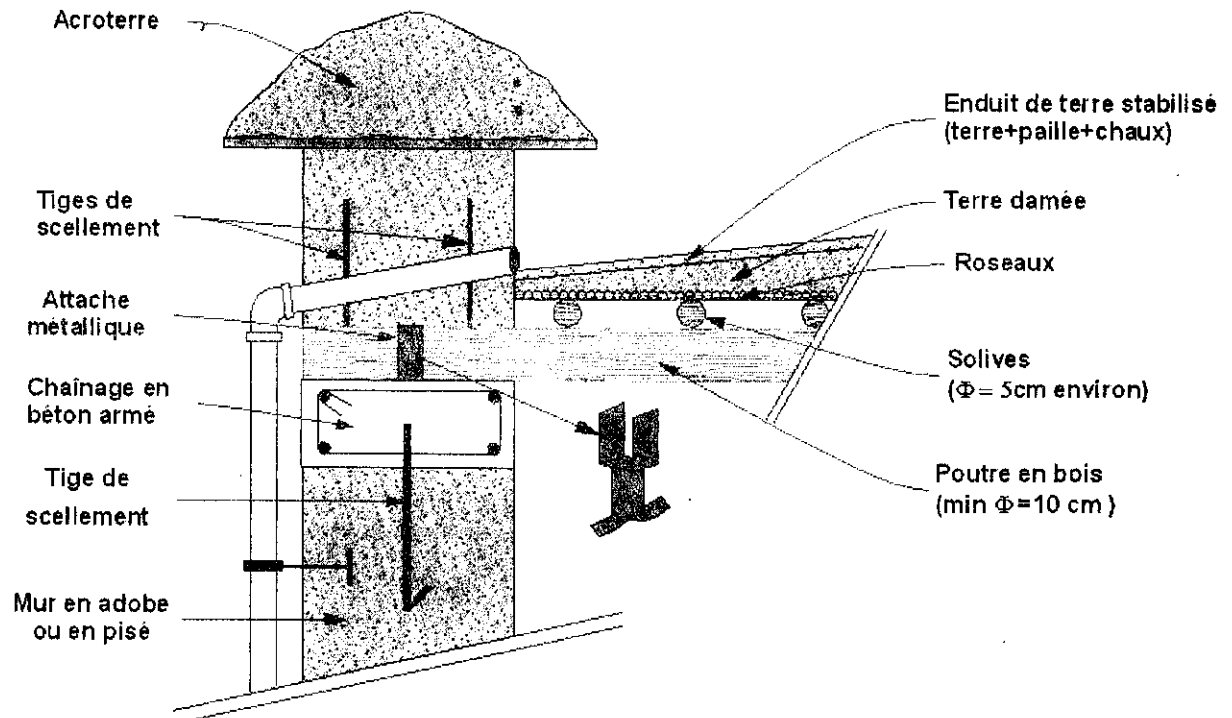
Chaînage horizontal en BA ; Toiture traditionnelle et attaches mur – chaînage et plancher –chaînage
